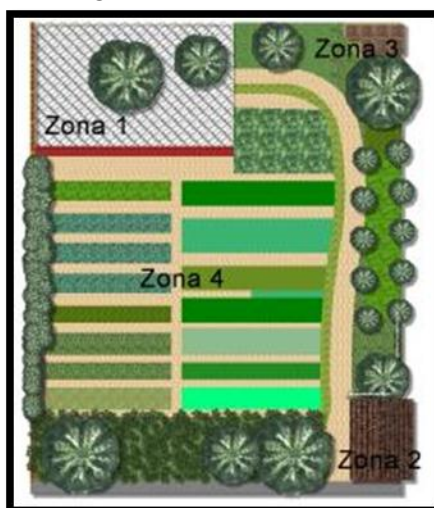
Detaliu plan existent 2 D (foto original)
